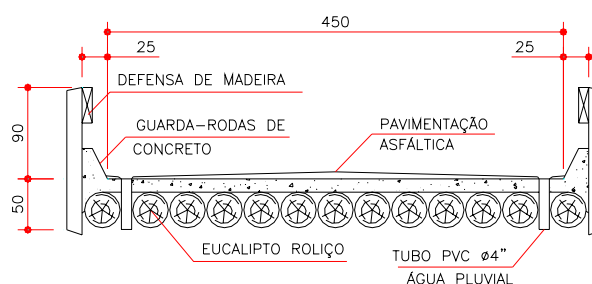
Seção transversal da ponte em placa mista de madeira-concreto com uma faixa de tráfego
